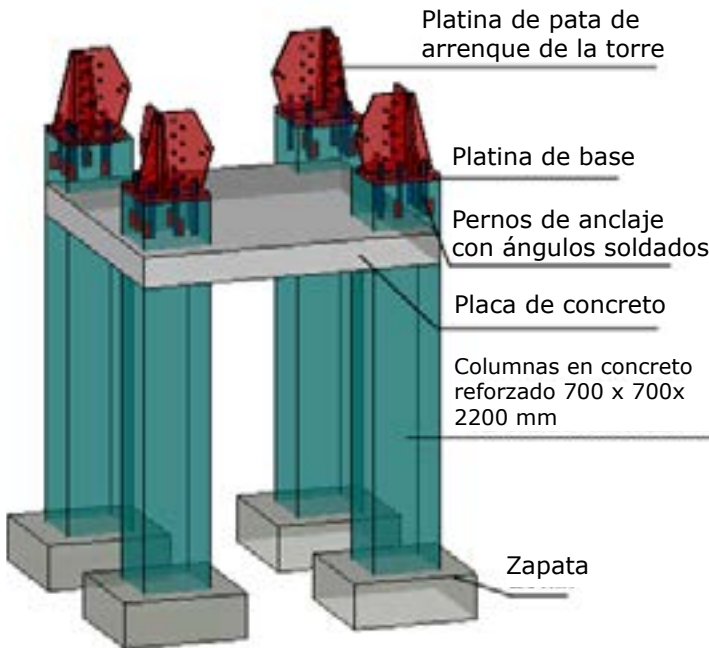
Detalle general de perno de anclaje. Autoría propia.
